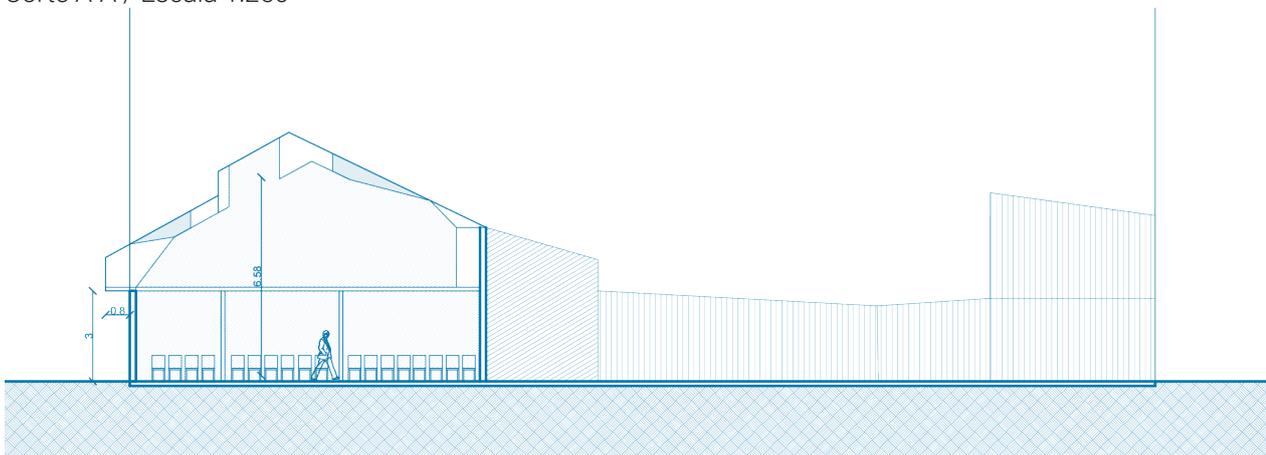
Planimetría Propuesta, lugar de culto. Caso 03
